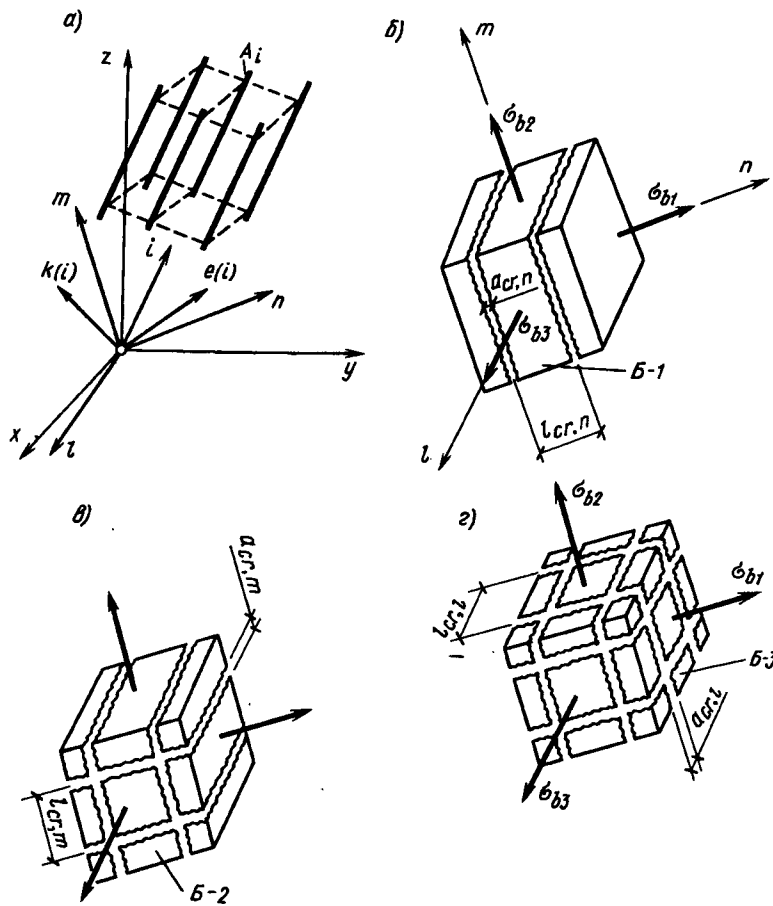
Общая схема армирования и схемы трещин а — наклонное (произвольно-ориентированное) армирование; б-г — три схемы трещин (1-3); А₁ — арматурные стержни. Б-1, Б-2, Б-3 — блоки бетона между трещинами
